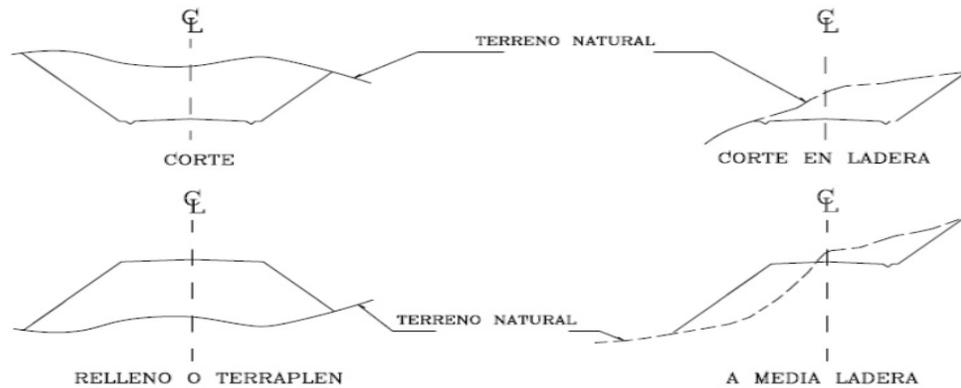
Secciones Transversales de Corte y Relleno, Topografía Álvaro
